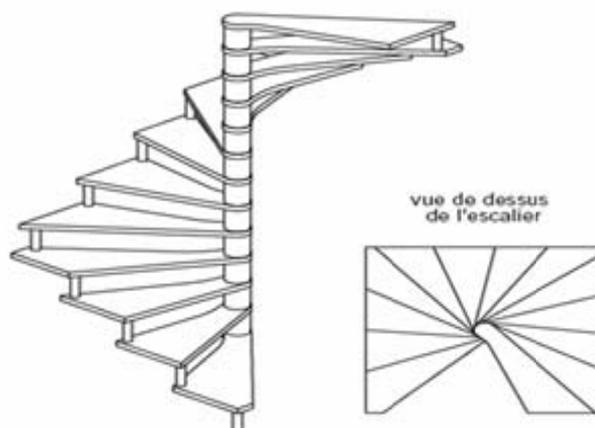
Escalier hélicoïdal en bois sur plan carré.
